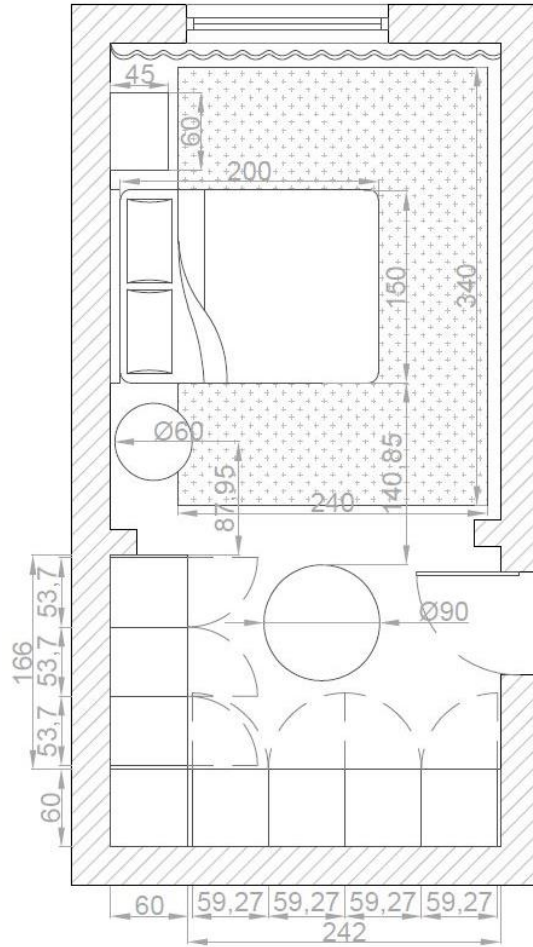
Planta de Equipamento Quarto Casal Joana G.
